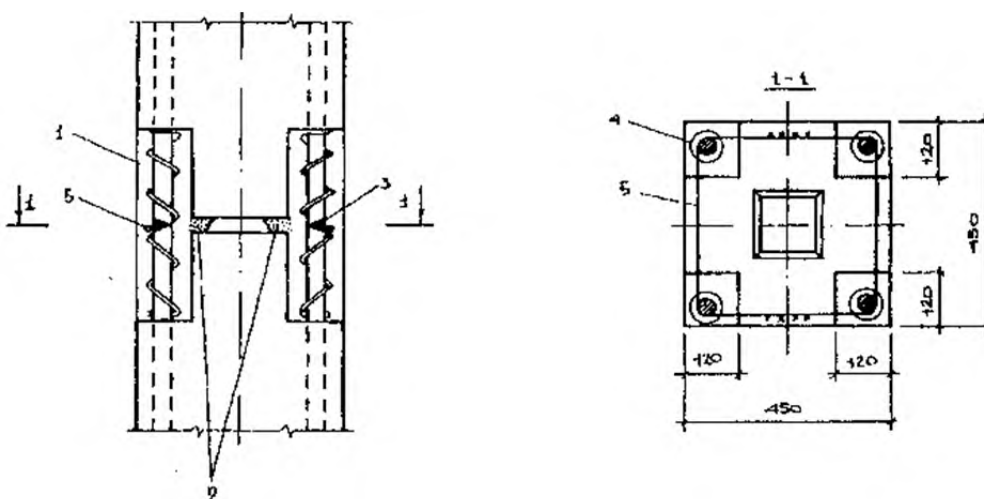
Стык колонн с ванной сваркой арматуры:
